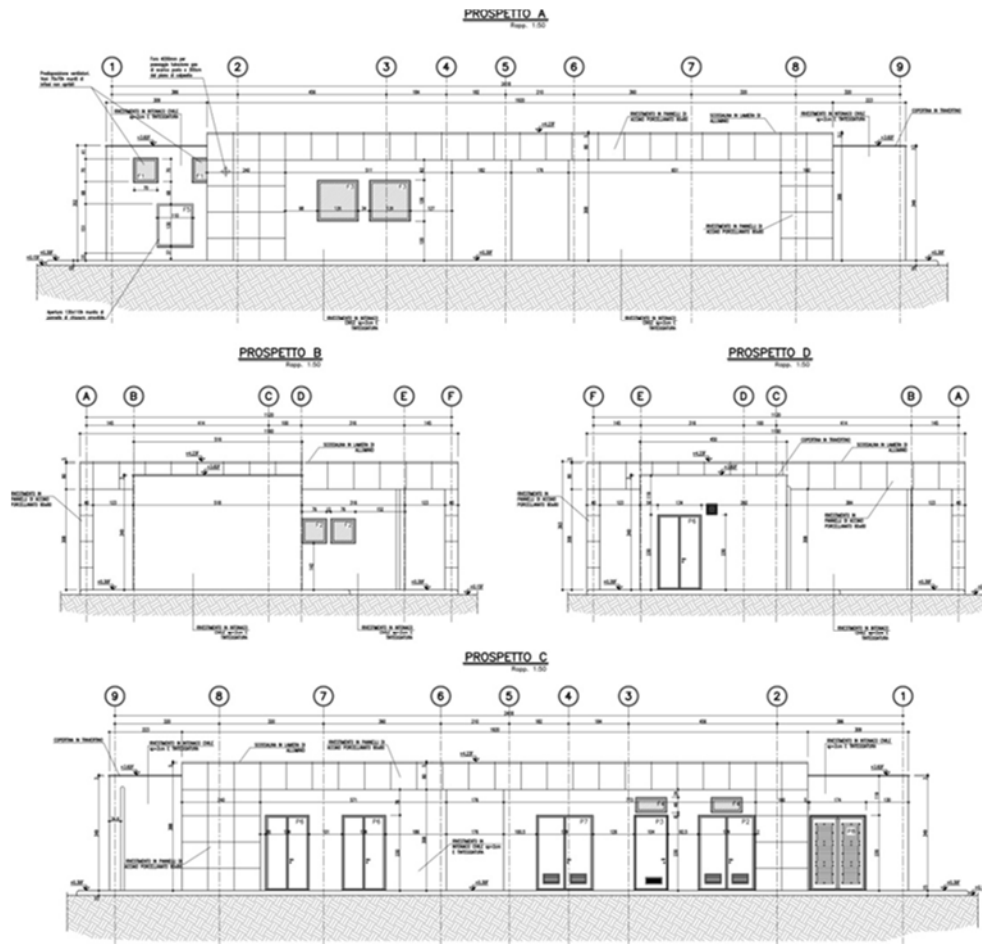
12 Fabbricato di stazione ed impianti - Pianta e Prospetti
